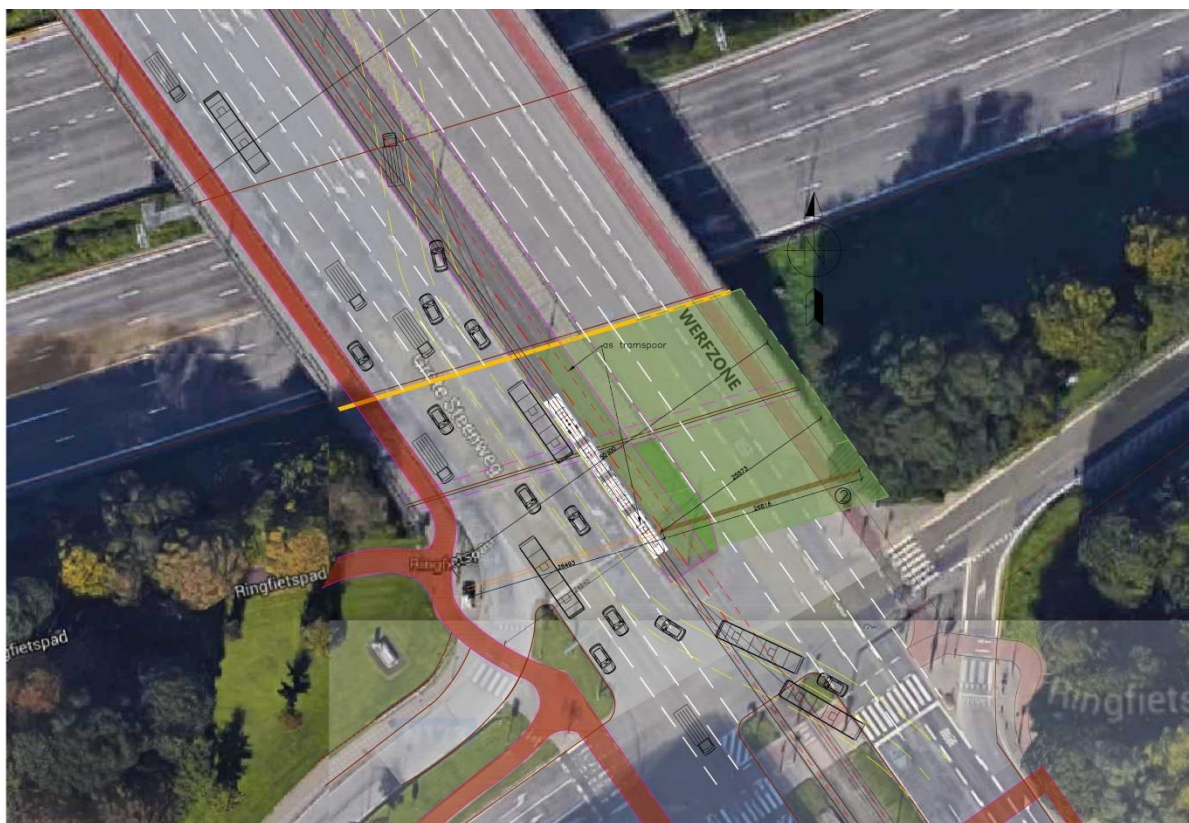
bovenzicht brug Grote Steenweg fase 2: uitvoering wand zijde richting centrum alle verkeer over 1 zijde (richting periferie)
